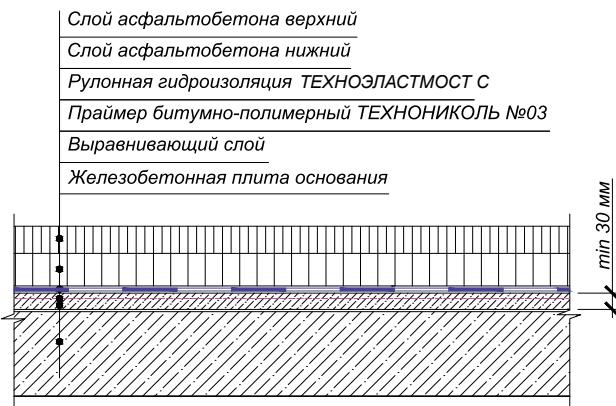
Конструкция дорожной одежды на железобетонной плите.
